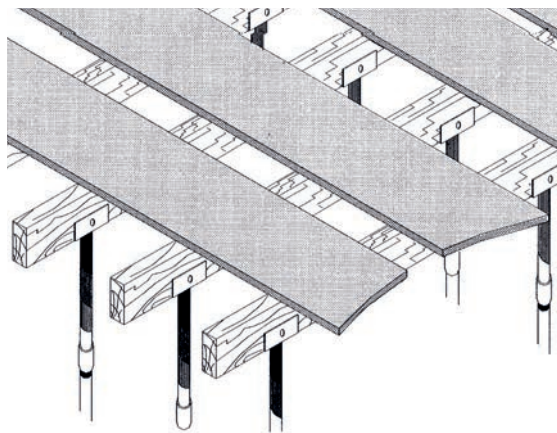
Pose et mise à niveau des planches ou bastaings
